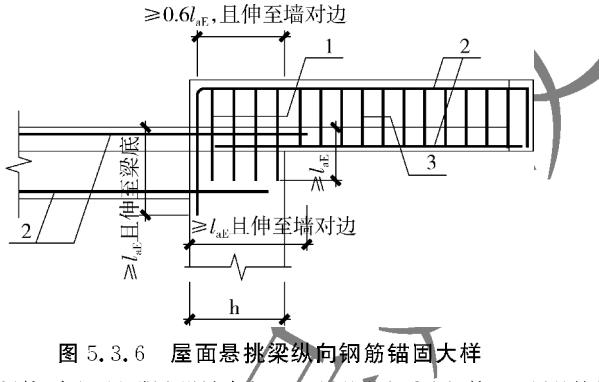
屋面悬挑梁纵向钢筋锚固大样
